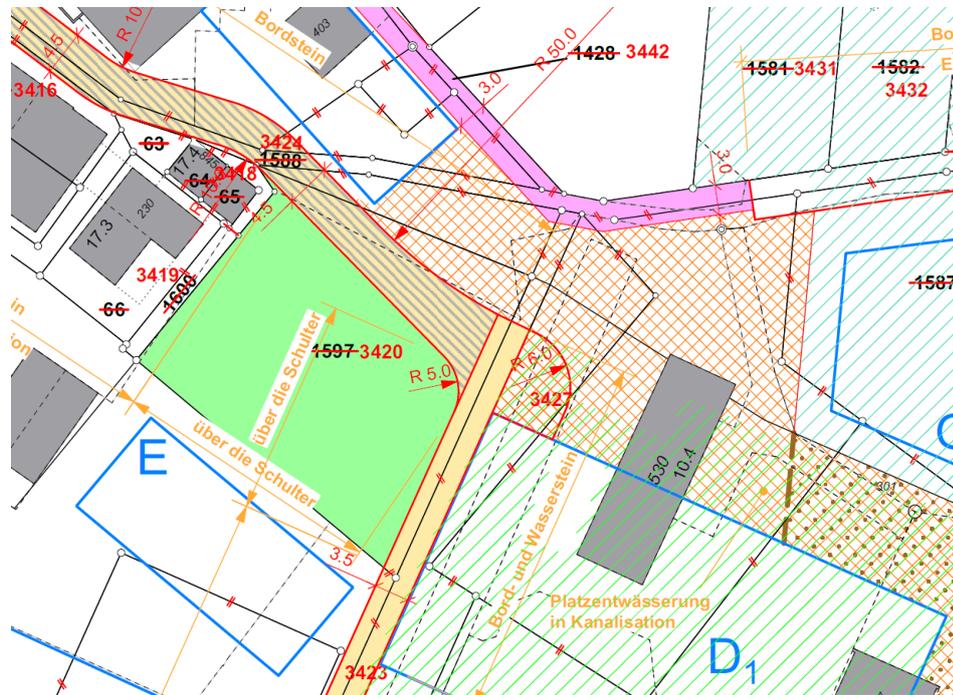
Einfahrtsbereich Tiefgarage Mitte, Plan «Erschliessung Strasse»
